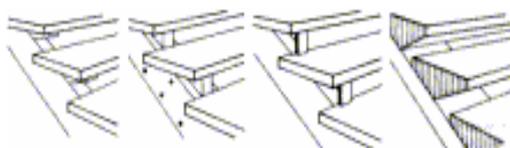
Degraus apoiados sobre vigas laterais e em consola
